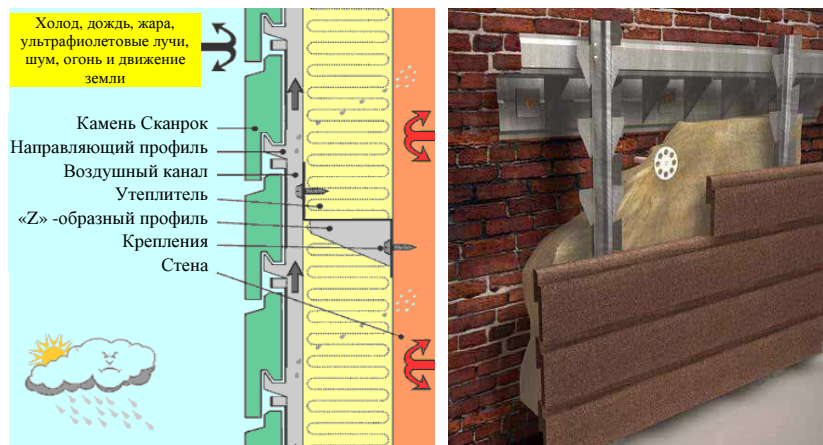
Схема вентилируемого фасада СКАНРОК
